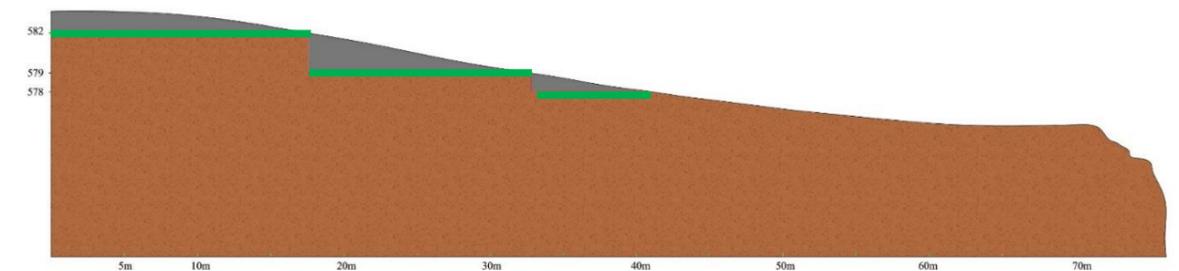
Plan des plateformes de l'assiette d'intervention..
